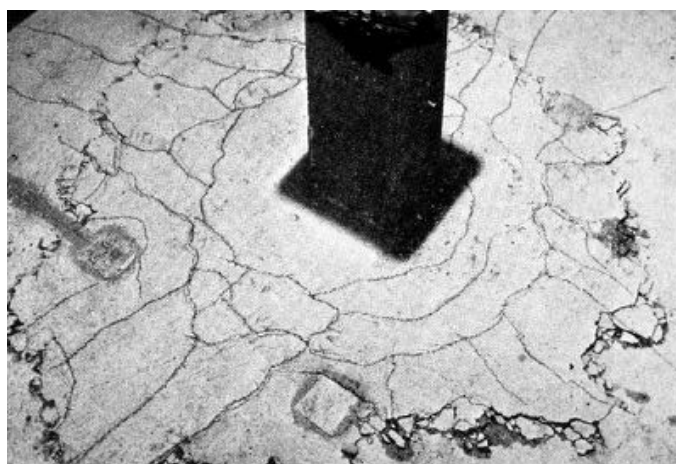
Rotura por punzonamiento. Se aprecian las fisuras por compresión (radiales) y las de tracción (concéntricas), hasta su rotura en forma de "tapón".
